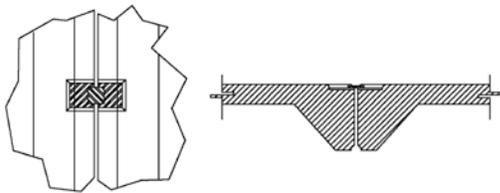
Detalle típico de unión temporal entre paneles verticales
